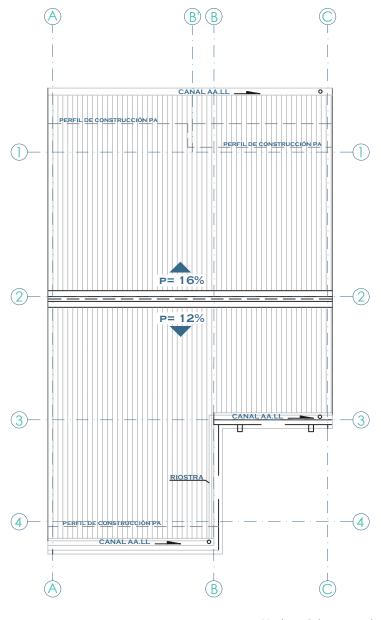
Planta Cubierta actual Nota: Elaborado por el autor
